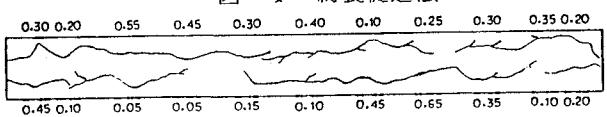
供試体底面劣化状況とひび割れ幅 (mm)
